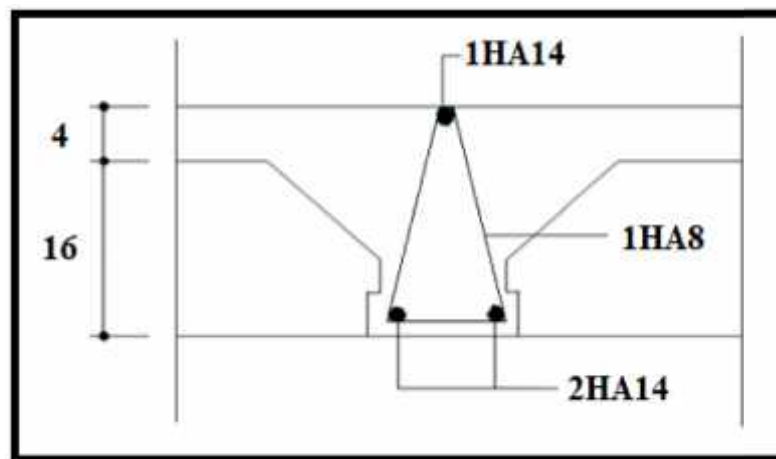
Schéma de ferrailage de la poutrelle étage courant.
